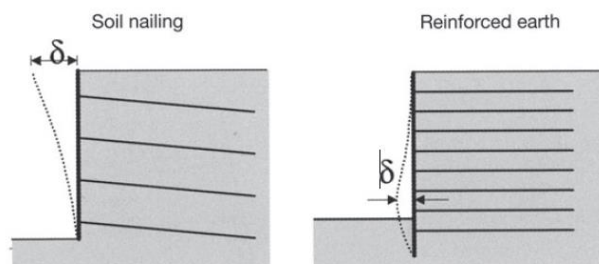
Comparação das deformações de face entre soil nailing (solo grampeado) e reinforced earth (solo reforçado).
